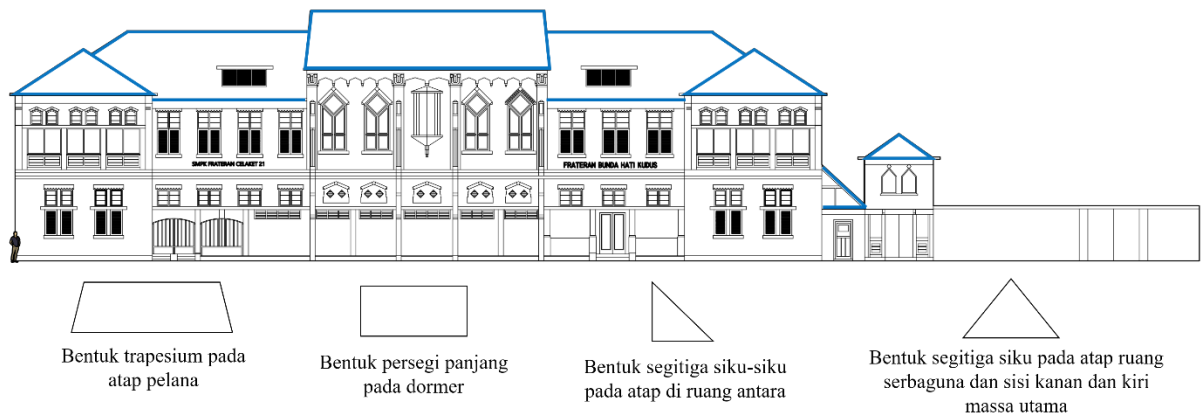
Tampak depan bangunan kompleks Sekolah Cor Jesu.
